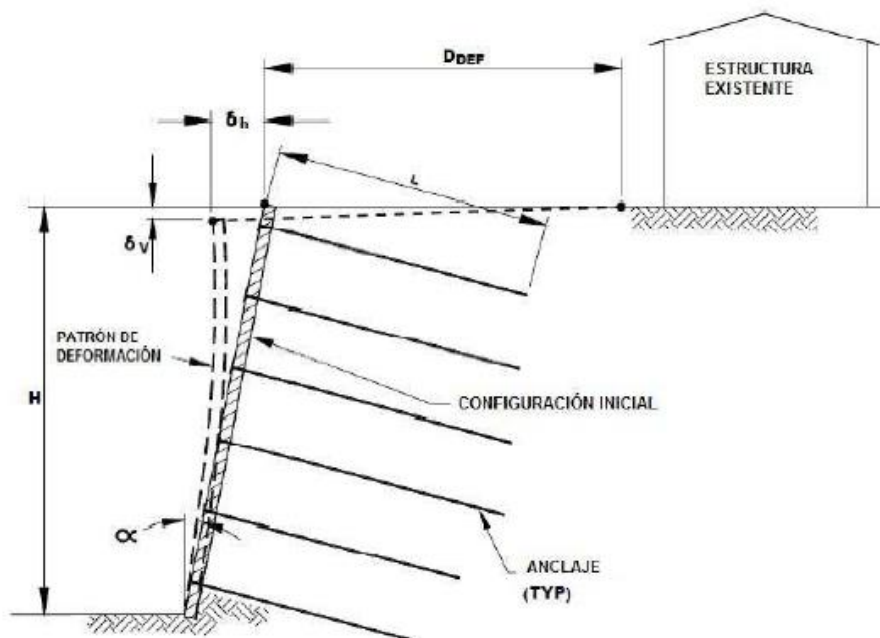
Deformación muro claveteado de concreto lanzado
